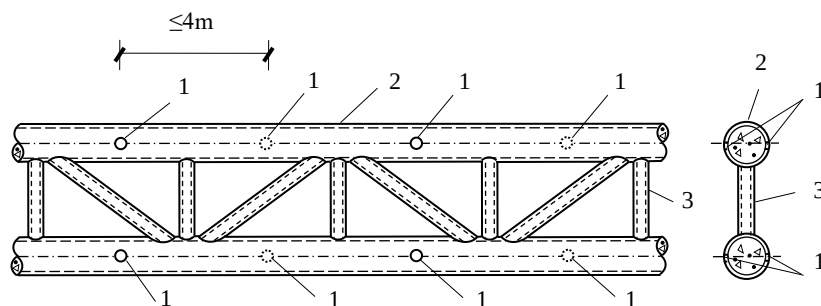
钢管混凝土桁式混合结构排气孔位置示意
